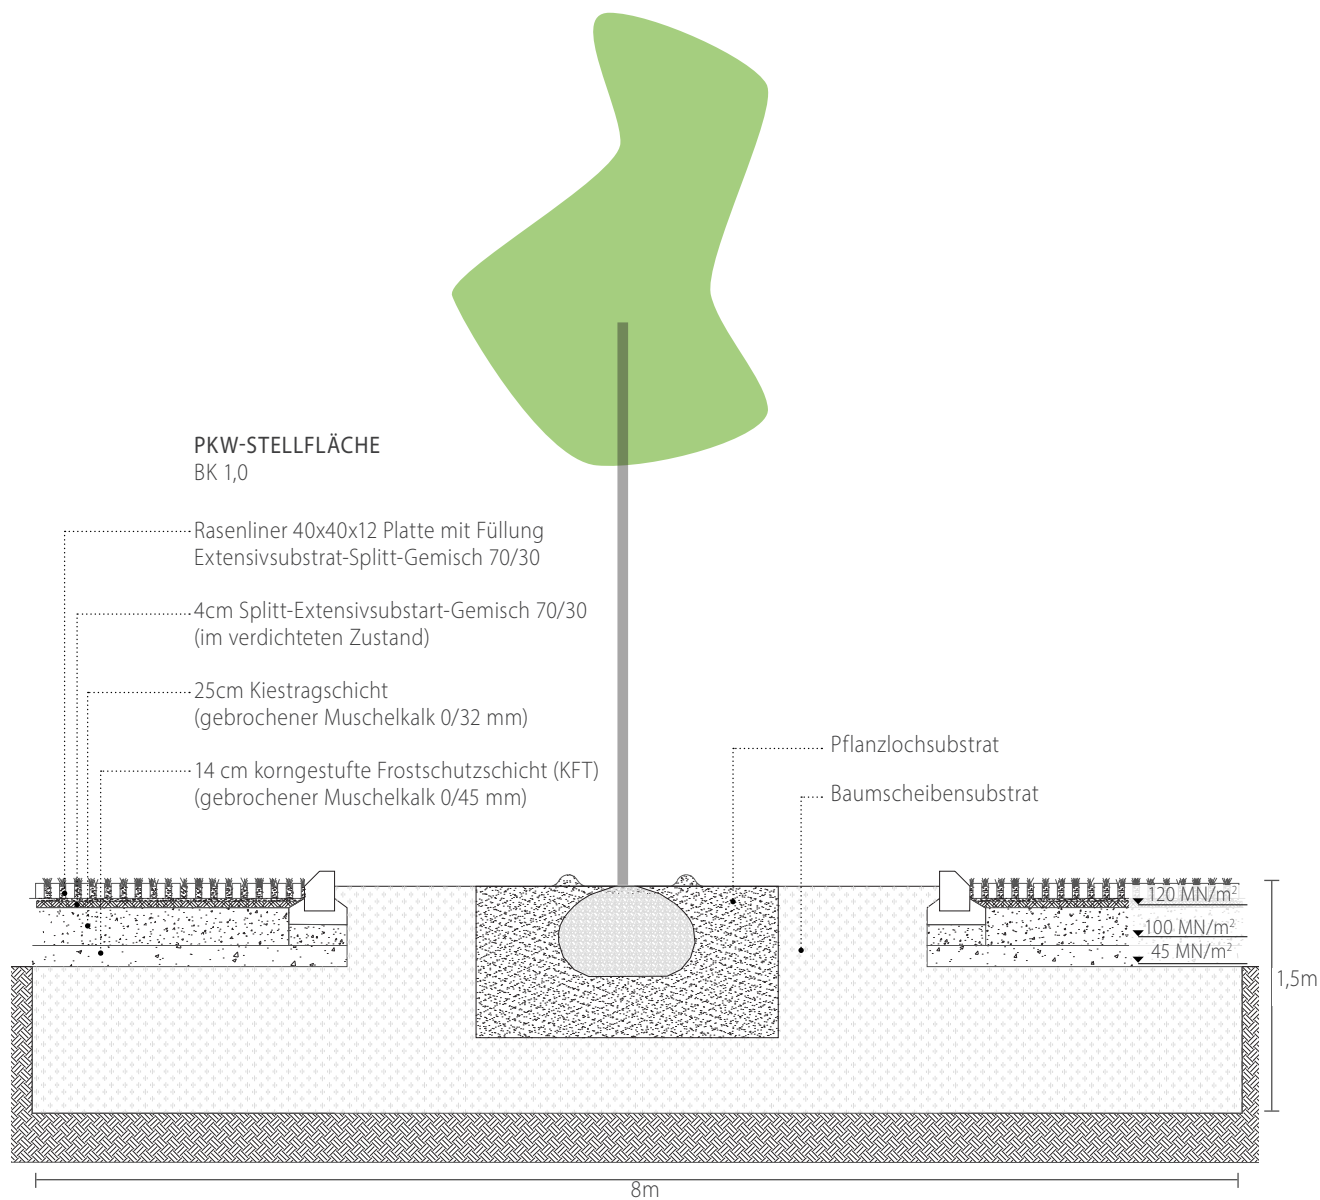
Detailsicht Bauweise 2: Schnittansicht B
